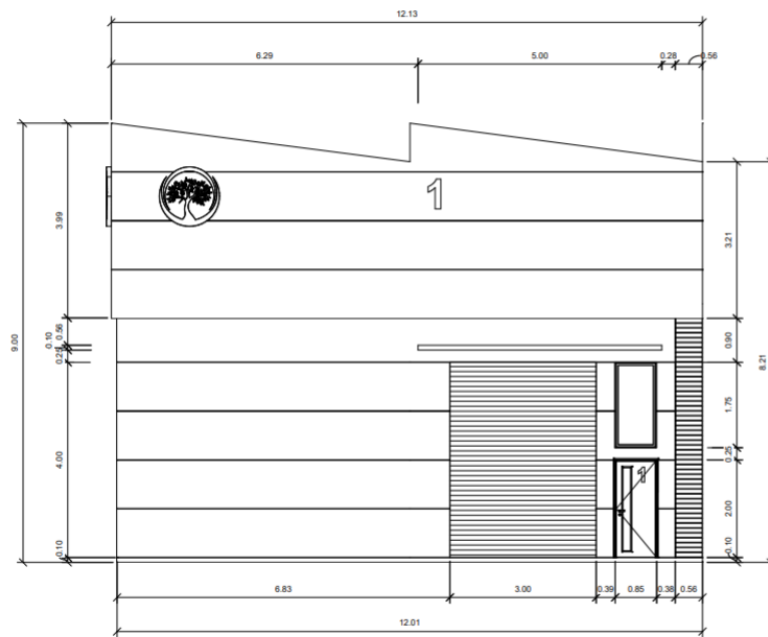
Diseño arquitectónico de la fachada de las Bodegas
